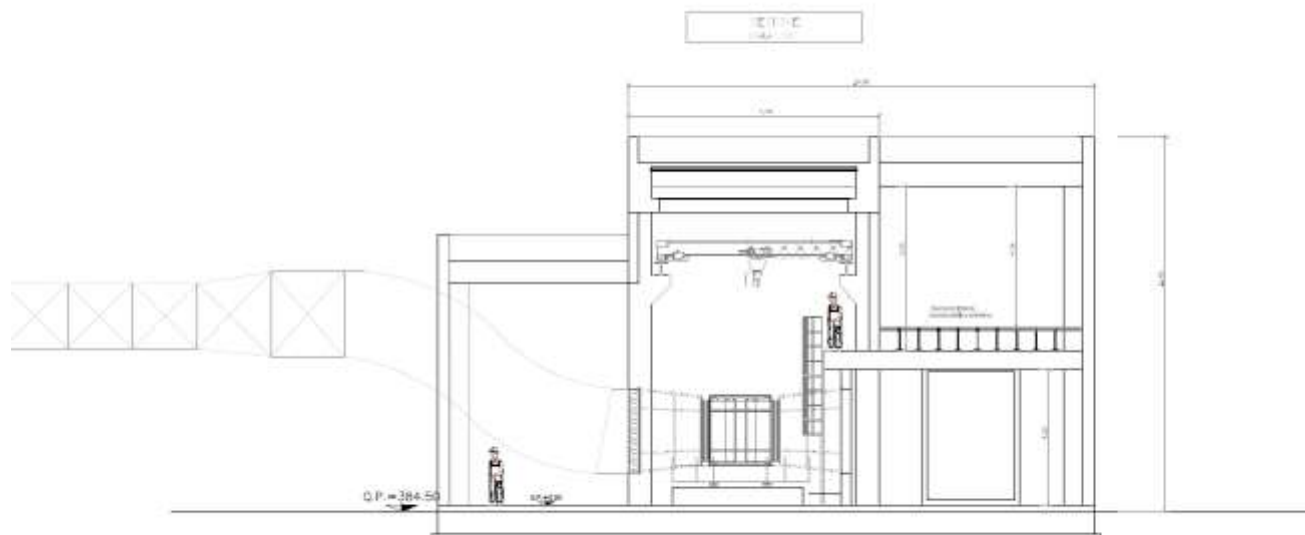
Sezione - Fabbricato FAVV – progetto in variante
